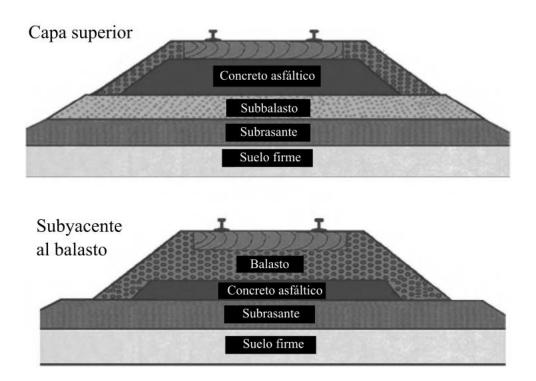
Configuraciones de vía férrea con capa de concreto asfáltico, modificado de [5]
